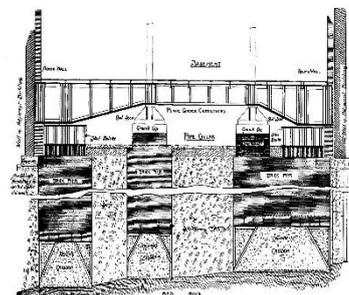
fondation en caissons d'un gratte-ciel de 1898
